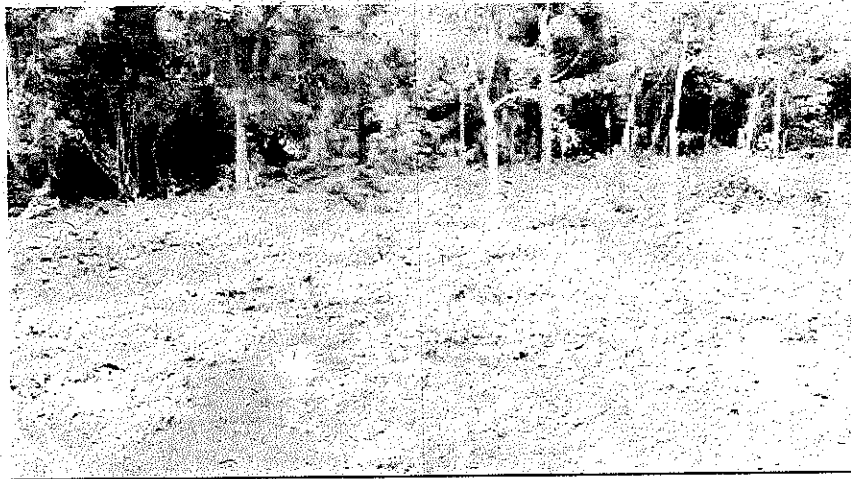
Aterro da área alagada e curso natural do córrego barreirinho com material de construção civil
